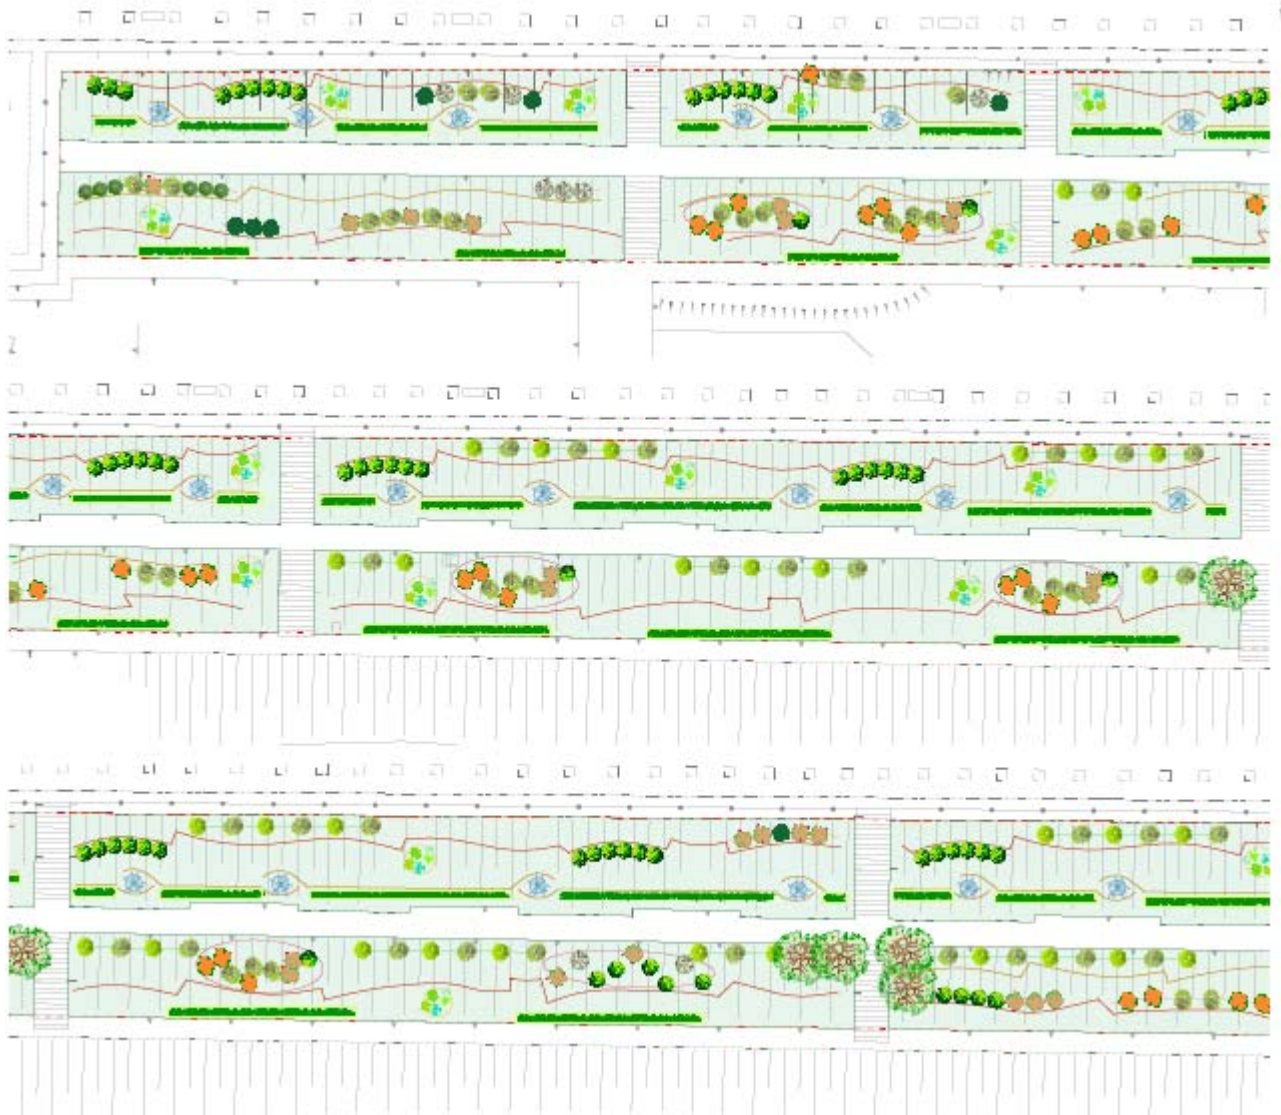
Estratto elaborato Planimetria opere verde (1 di 2)
